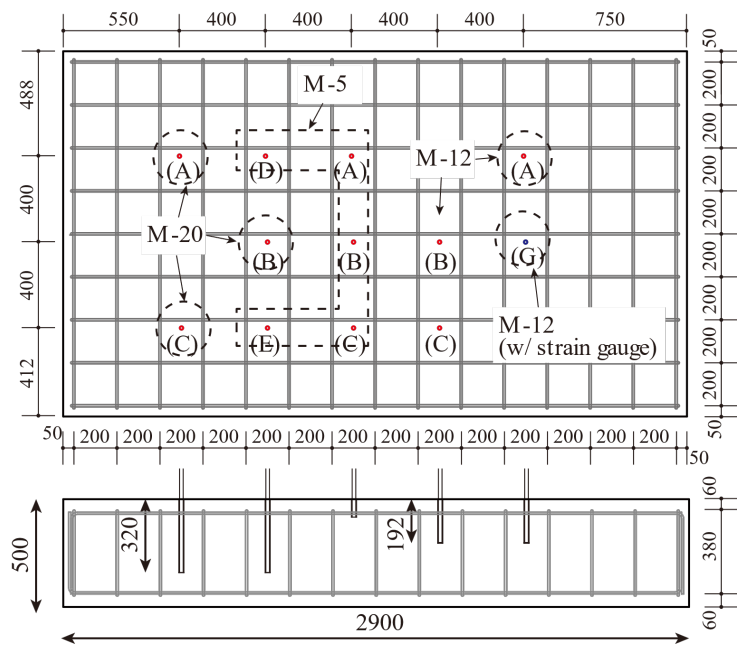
マットスタブ試験体 あと施工アンカー設置位置図
